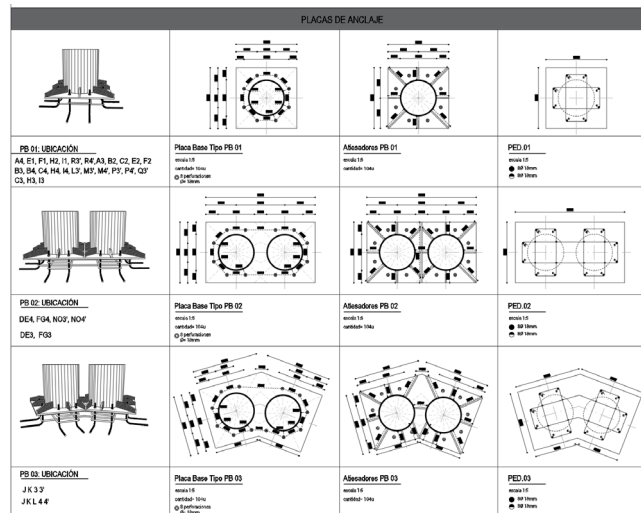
Cuadro de placas de anclaje. Elaboración: (Pérez, 2018)
